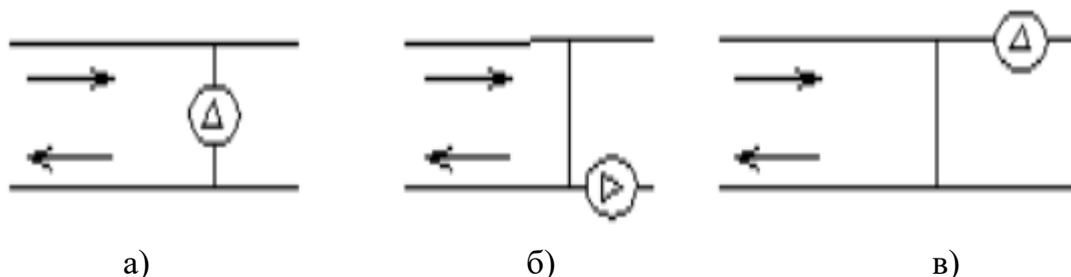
Схемы подключения смесительных насосов: а) на перемычке, б) на обратном трубопроводе, в) на подающем трубопроводе
